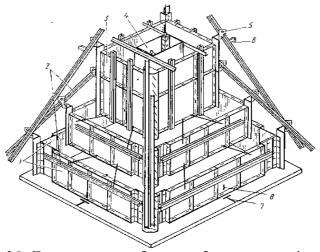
Пример компоновки блока опалубки ступенчатого фундамента: 1 – угловые щиты опалубки; 2 – схватки; 3 – опалубка верхней ступени; 4 – стаканообразователь; 5 – флажки; 6 – монтажные петли; 7, 8 – установочные риски на бетонной подготовке и нижней ступени щитов
